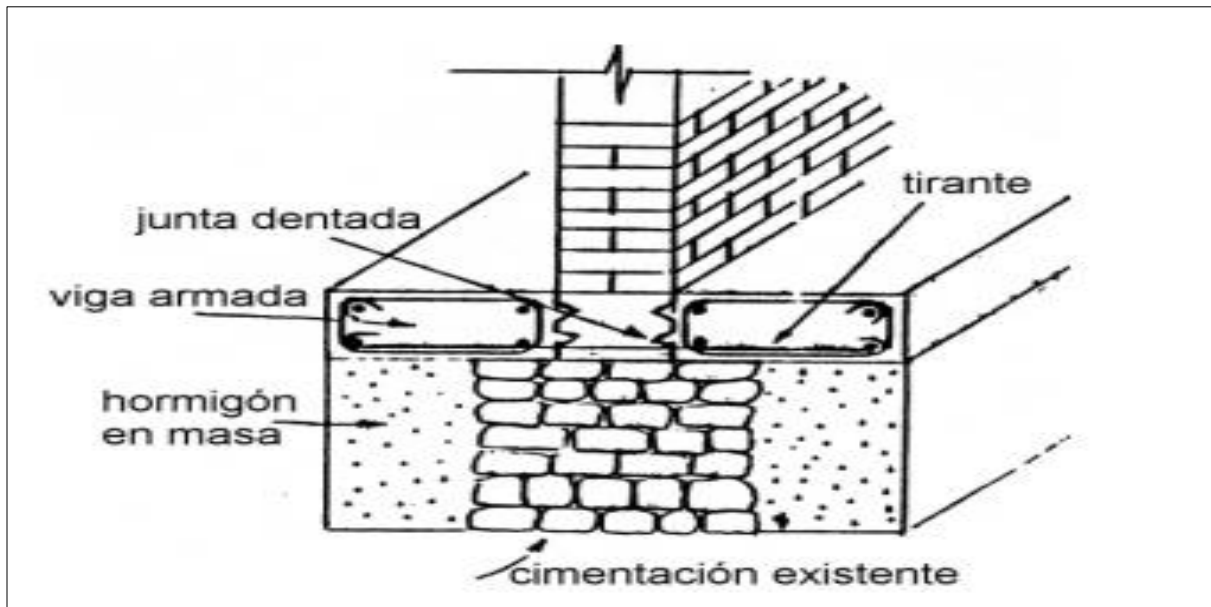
Hormigón en masa y doble viga armada con tirantes
